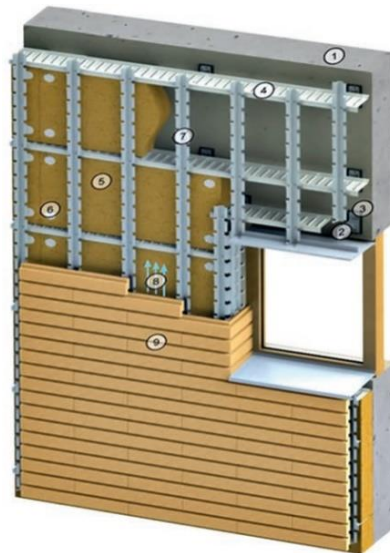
Схема утеплення фасаду вентилятованими системами Scanroc. 1– Стіна будинку; 2 – Консоль; 3 –Термоізоляційна прокладка; 4 – Горизонтальний профіль; 5 – Утеплювач; 6 – Тарілчастий дюбель; 7 – Вертикальний профіль; 8 –Повітряний канал 9 – Фасадний камінь SCANROC (600 мм) або SCANROC cottage (300 мм)
